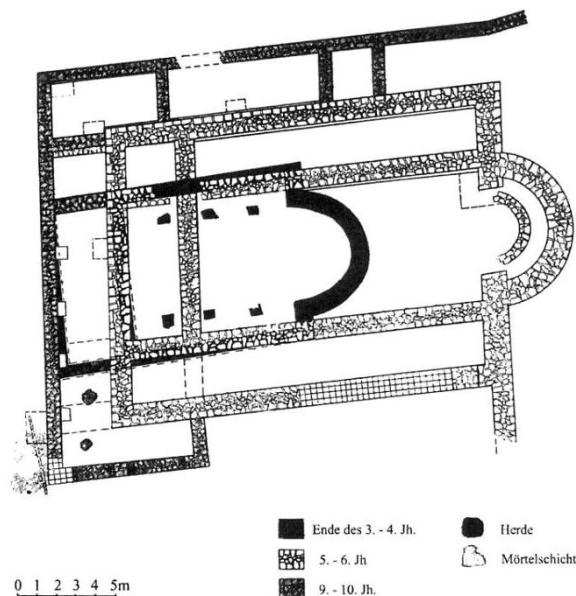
Car Krum, Kirche Nr. 3 = II und Nachfolgebauten, Grundriss (nach M. OPPERMANN, *Das frühe Christentum*, Taf. 26 Abb. 3)
